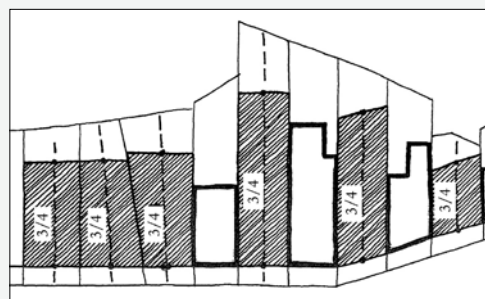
B: bepaling van de bebouwbare zone. (art. 4, § 1, 1°).
